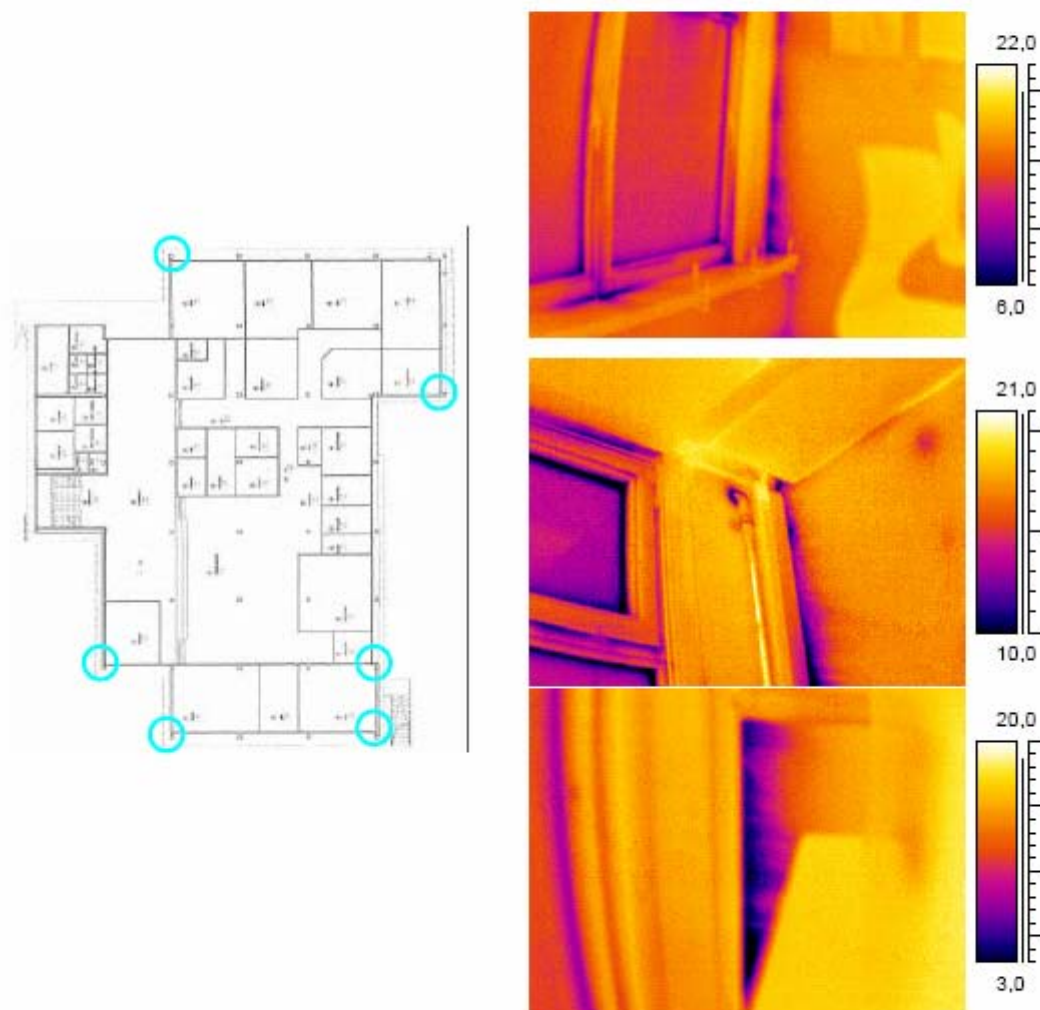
Anschluß der Fenster oder Wandelemente an die Betonwände im Erdgeschoß
